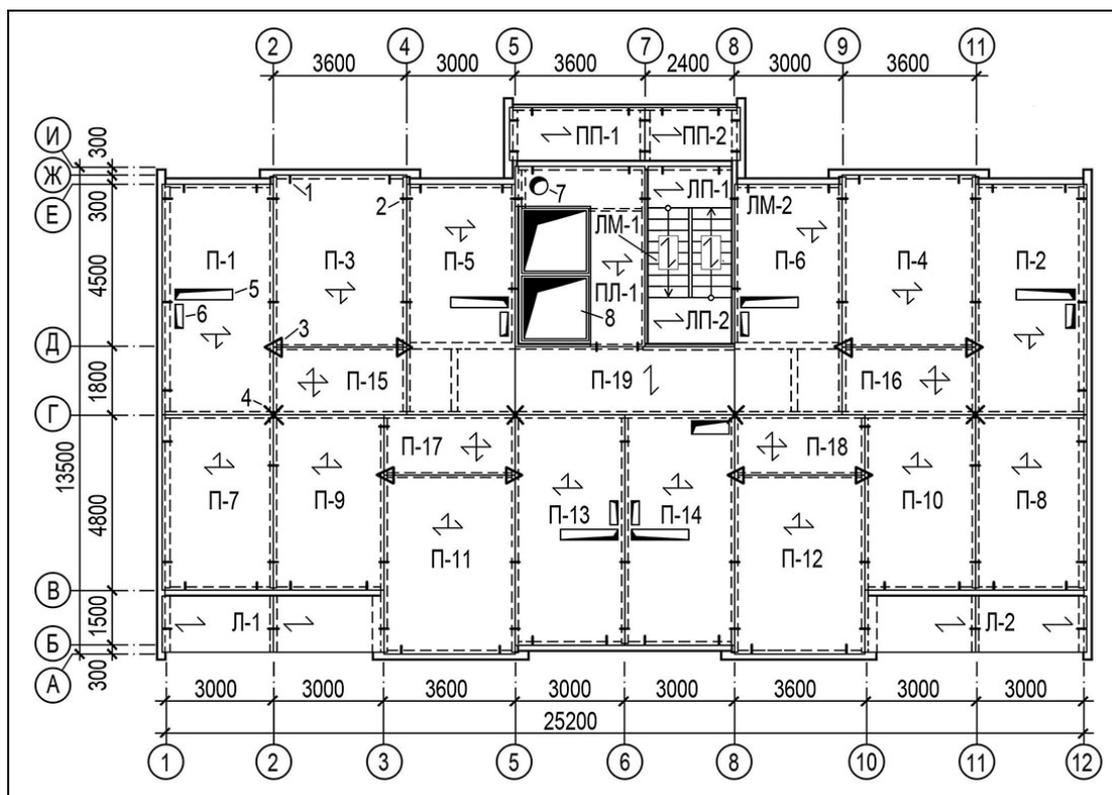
План несущих конструкций междуэтажного перекрытия здания, план типового этажа которого показан на рисунке 1.8.14
